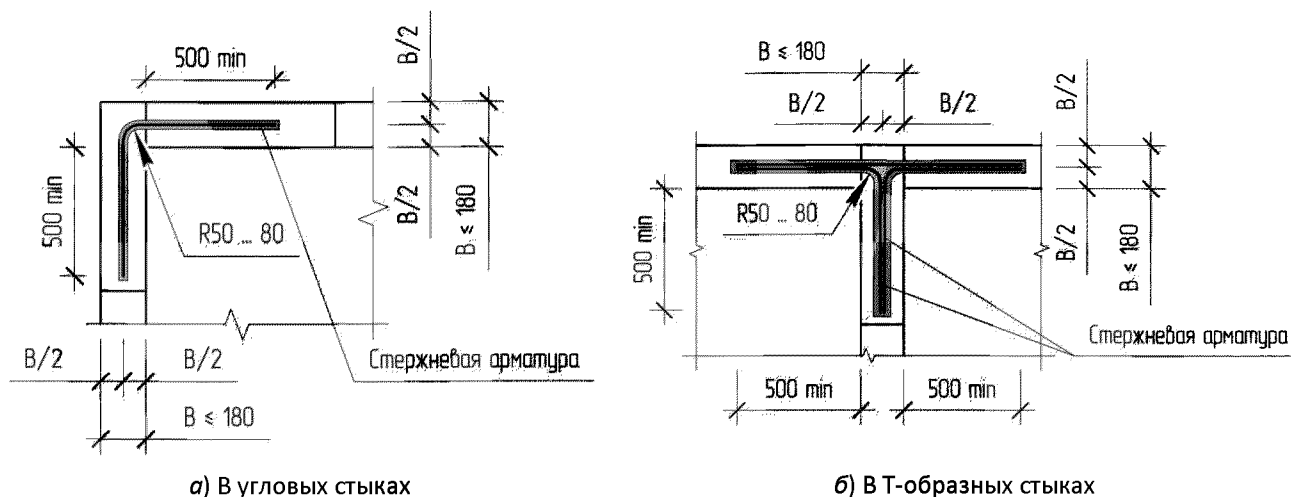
Пример раскладки арматурных стержней на пересечении стен (при толщинах стен до 180 мм)
